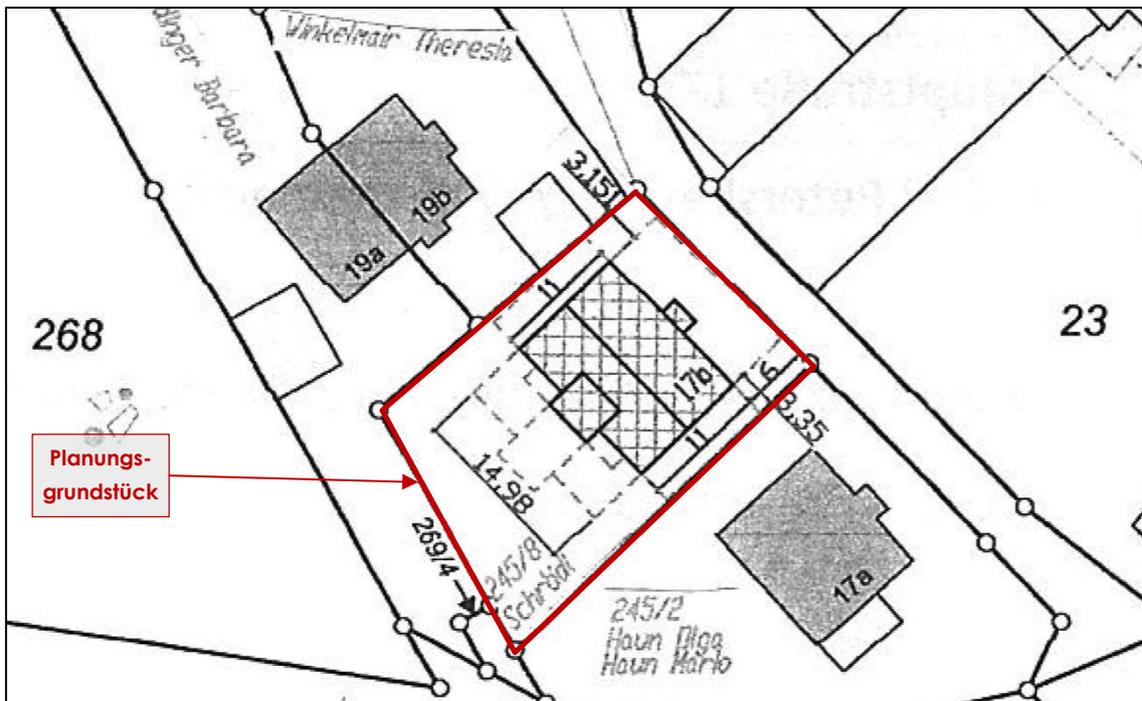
Lageplan mit Kennzeichnung des Planungsgrundstücks
